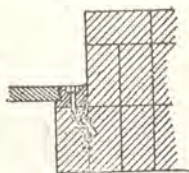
Modo di murare il telaio delle porte contro la mazzetta.
